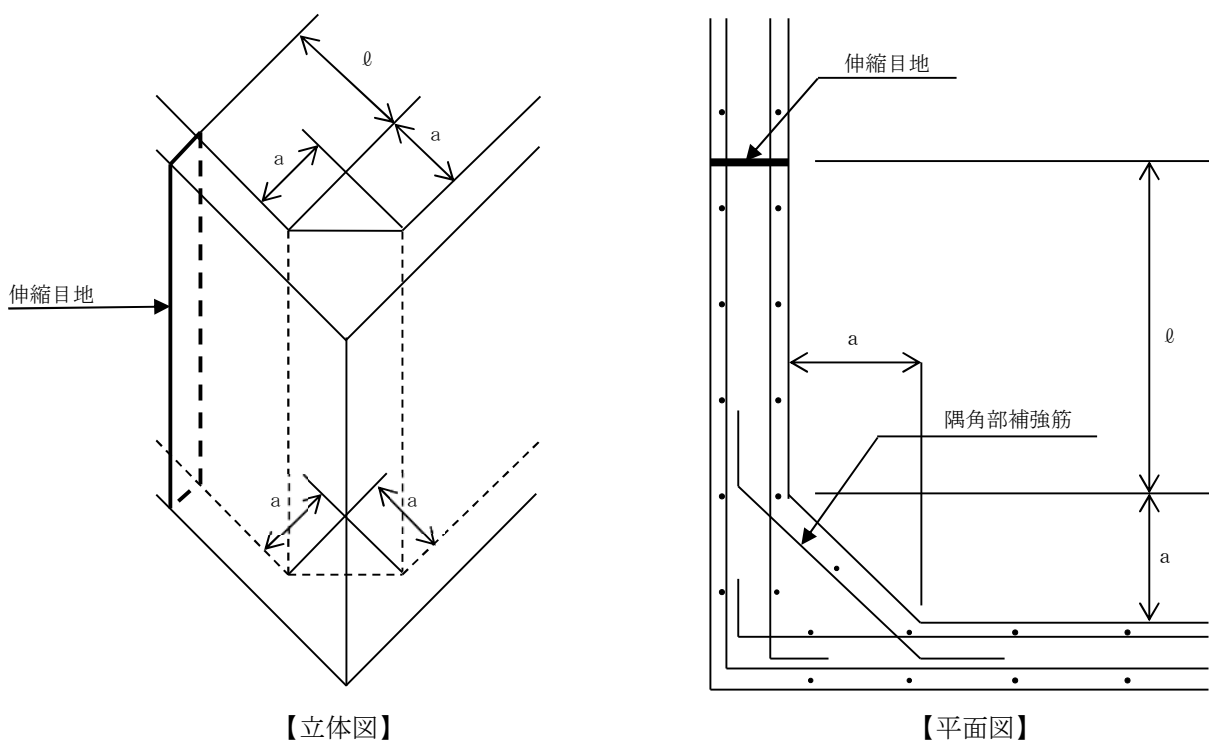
隅角部の補強方法及び伸縮目地の位置（概念図）
